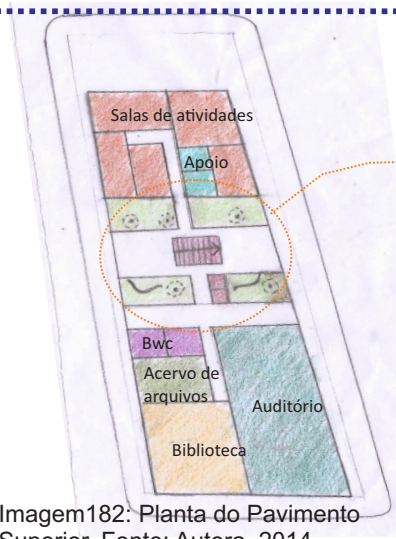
Planta do Pavimento Superior. Fonte: Autora, 2014
